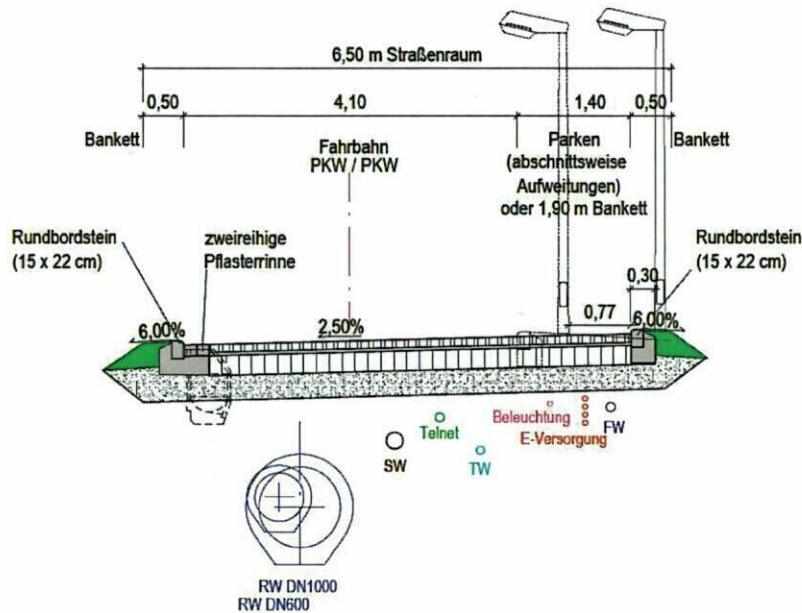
Querschnitt Planstraße B.1 (Wohnstraße)
